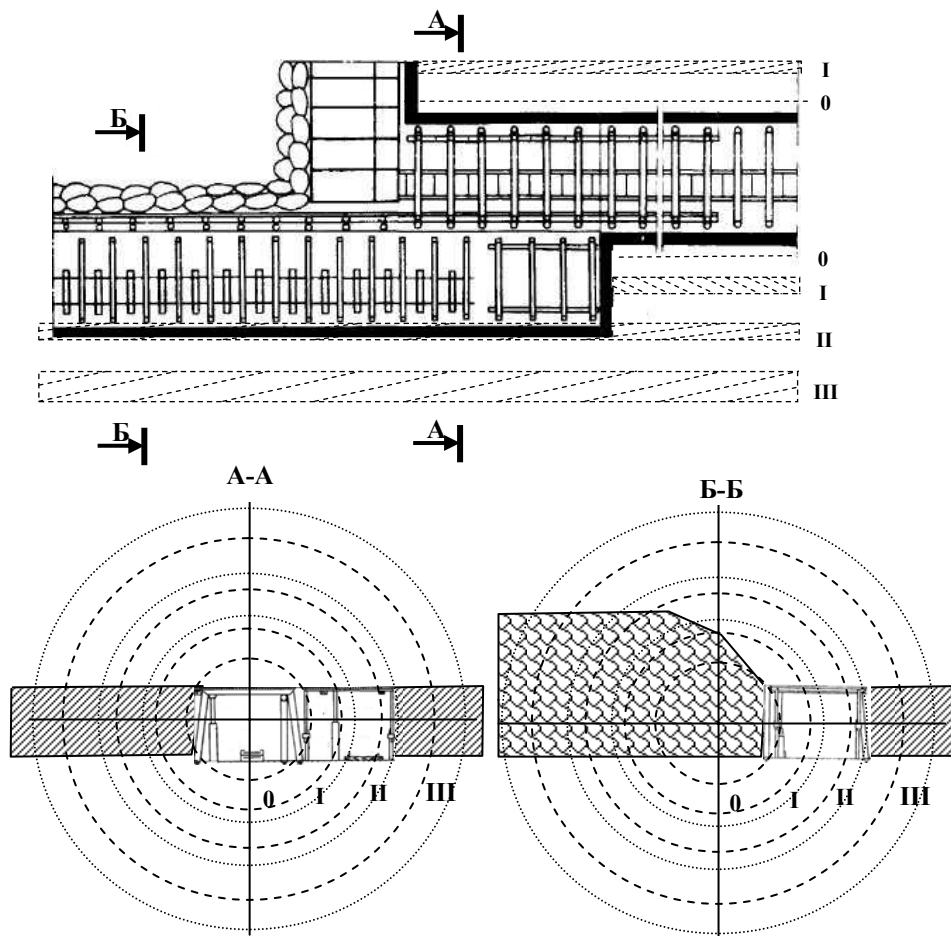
Формирование подготовительной выработки на границе с выработанным пространством
